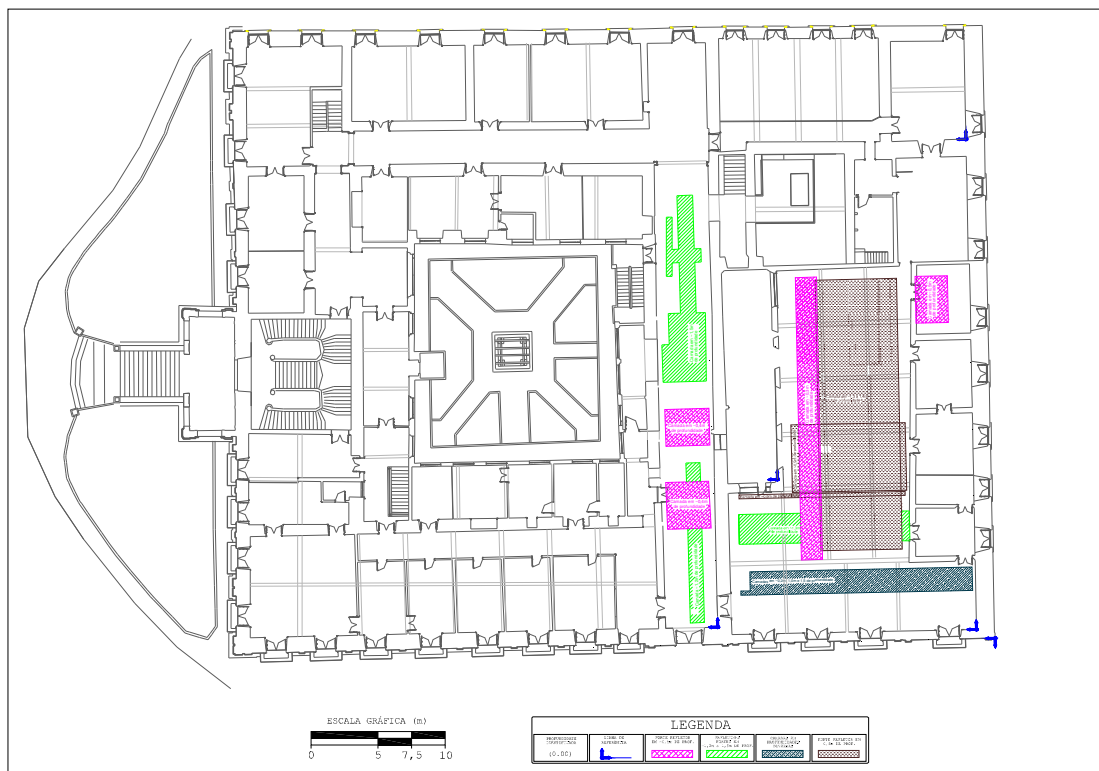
Linhas de aquisição com o GPR no 1º pavimento.
